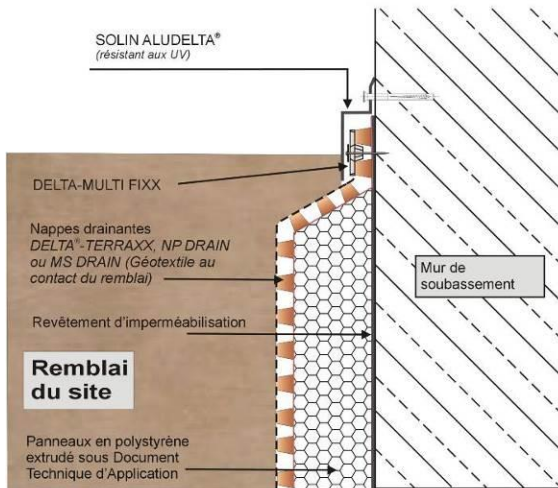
Nappe à excroissances drainante sur panneau en polystyrène extrudé sous DTA + imperméabilisation ou étanchéité
